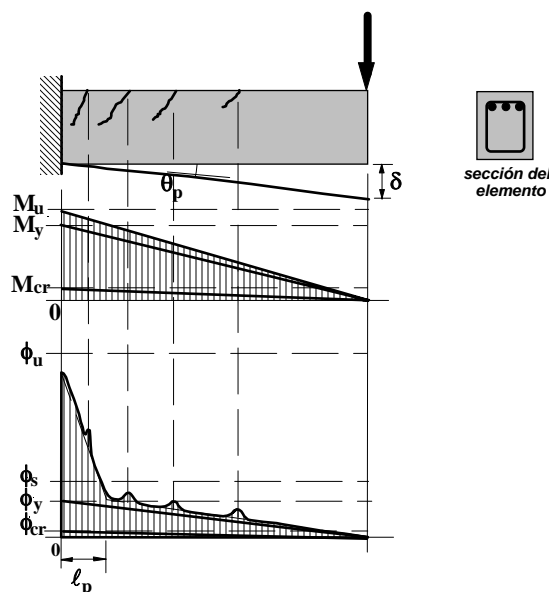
Distribución de la curvatura en una viga en voladizo que se lleva a la falla
